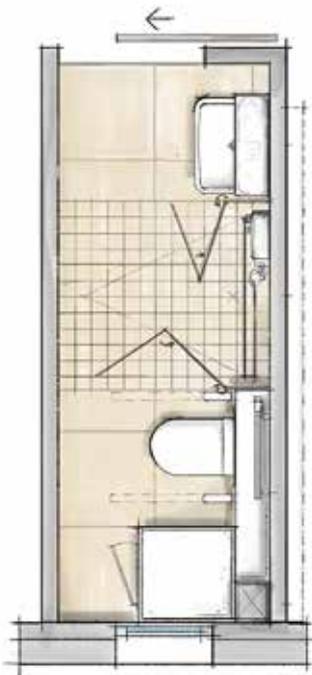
Umbauvariante 1 – Schlauchbad mit Assistenz an Waschtisch u. Toilette (Grundriss: DLW)
